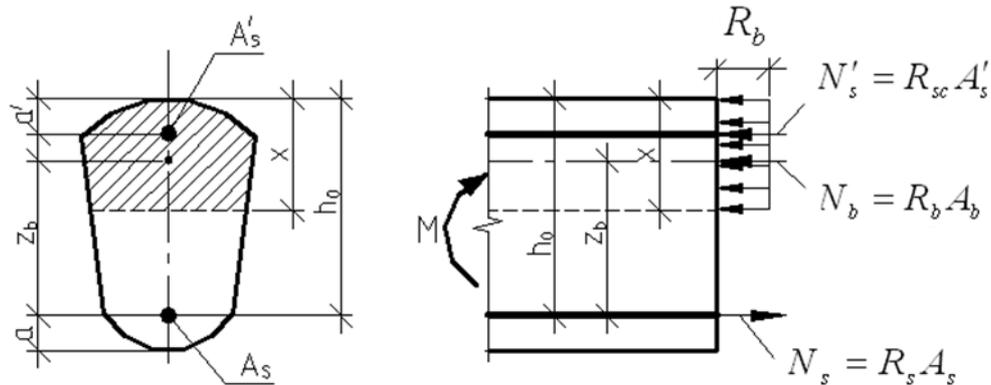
Схема усилий при расчете прочности изгибаемых элементов по нормальному сечению
